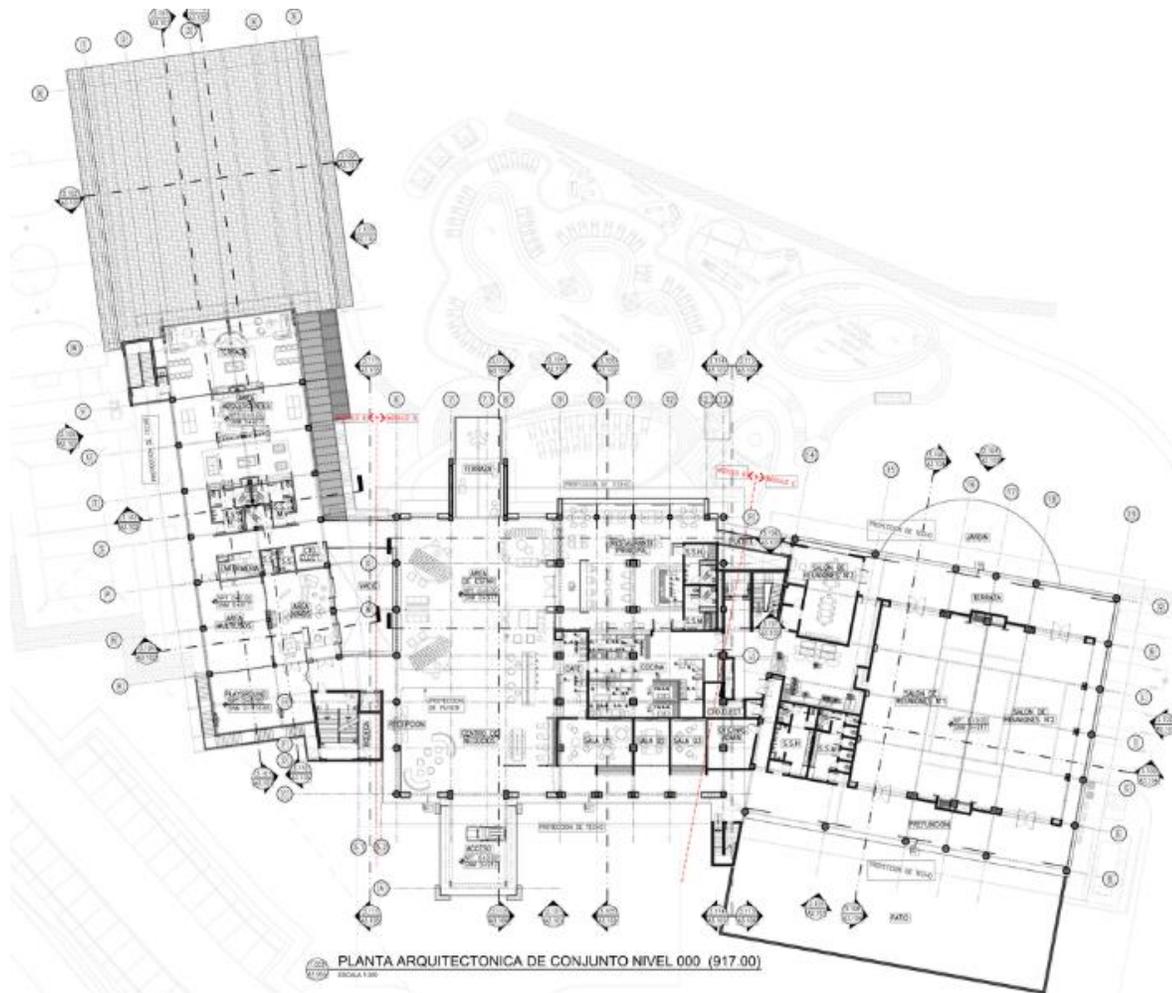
Planta arquitectónica de los tres módulos, nivel 917 (000). Fuente: EDIFICAR, 2018.
